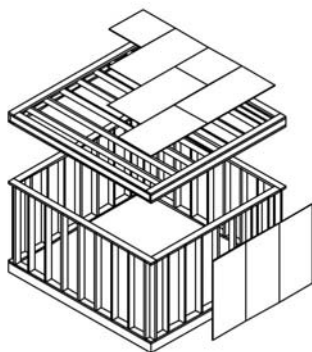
Schema Platform-Frame-Bauweise
